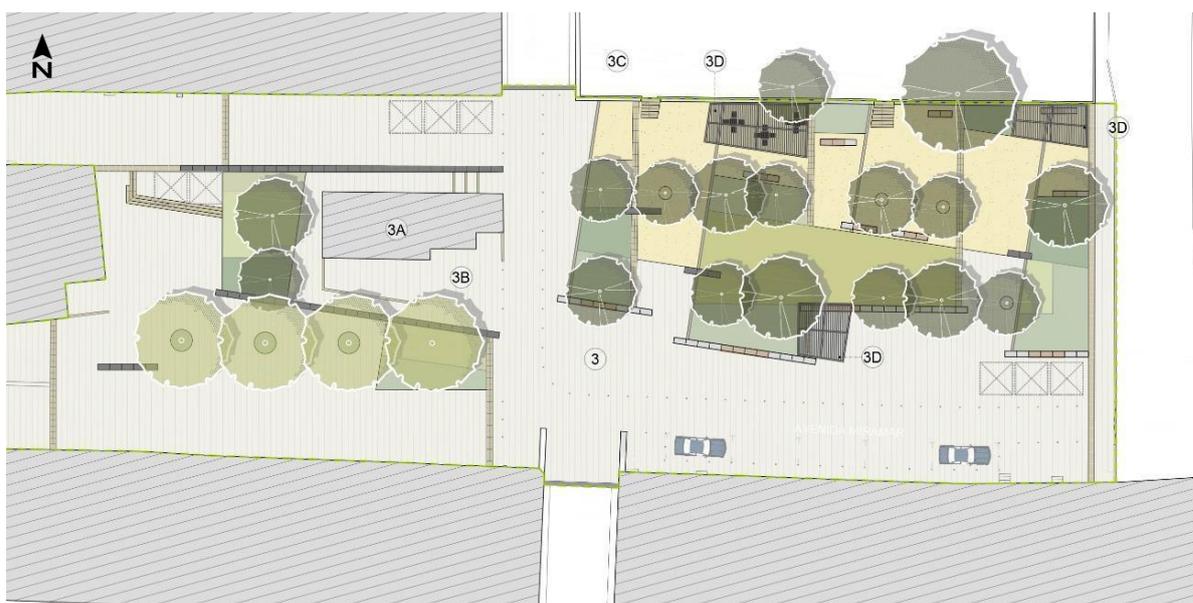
Zambujeira: Jardim da Zambujeira - Planta
